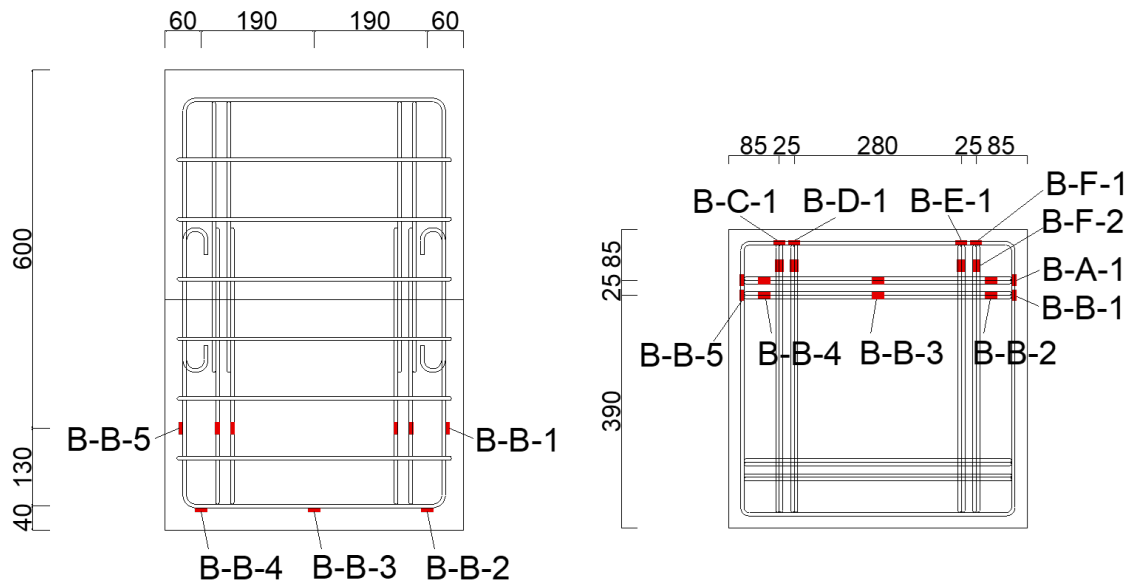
ベース筋ゲージ貼付位置 (A-1, B-1, C-1, C-3)
